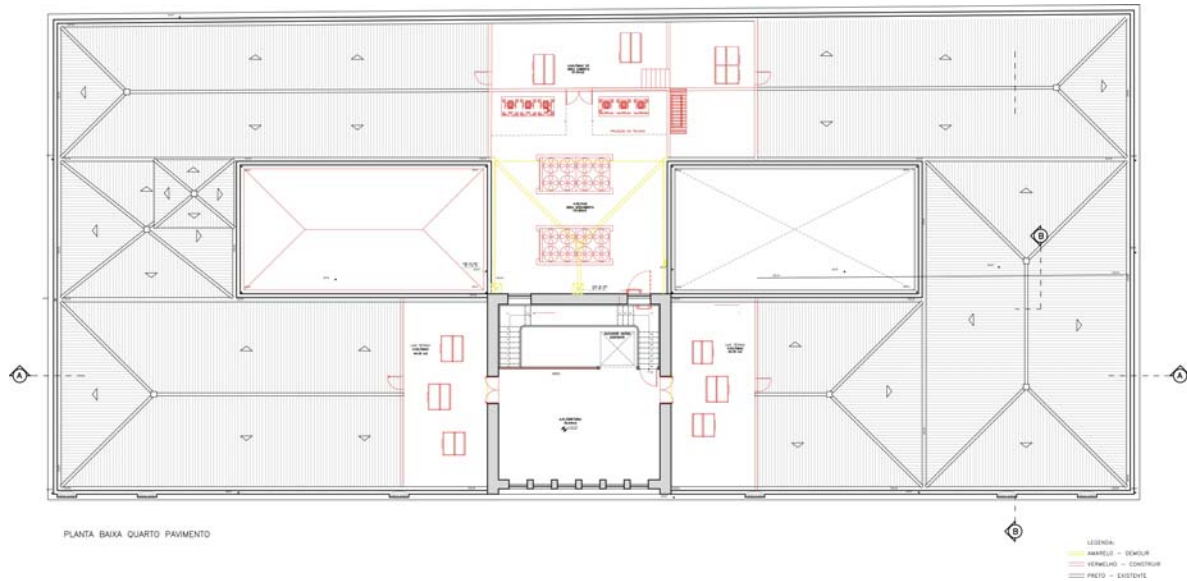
Planta baixa do projeto de restauração do prédio Principal – quarto pavimento.
